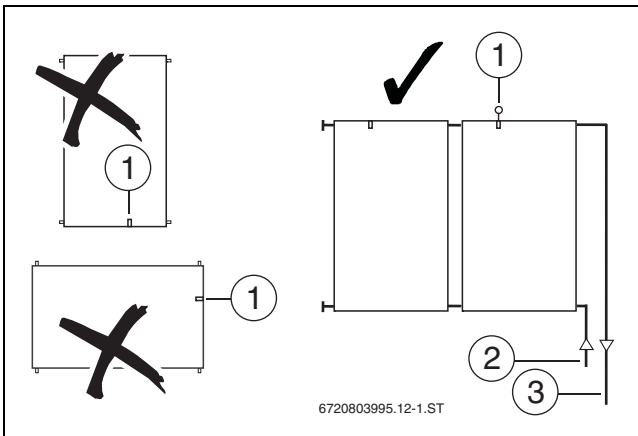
Zasilanie w przypadku dachowej centrali grzewczej
